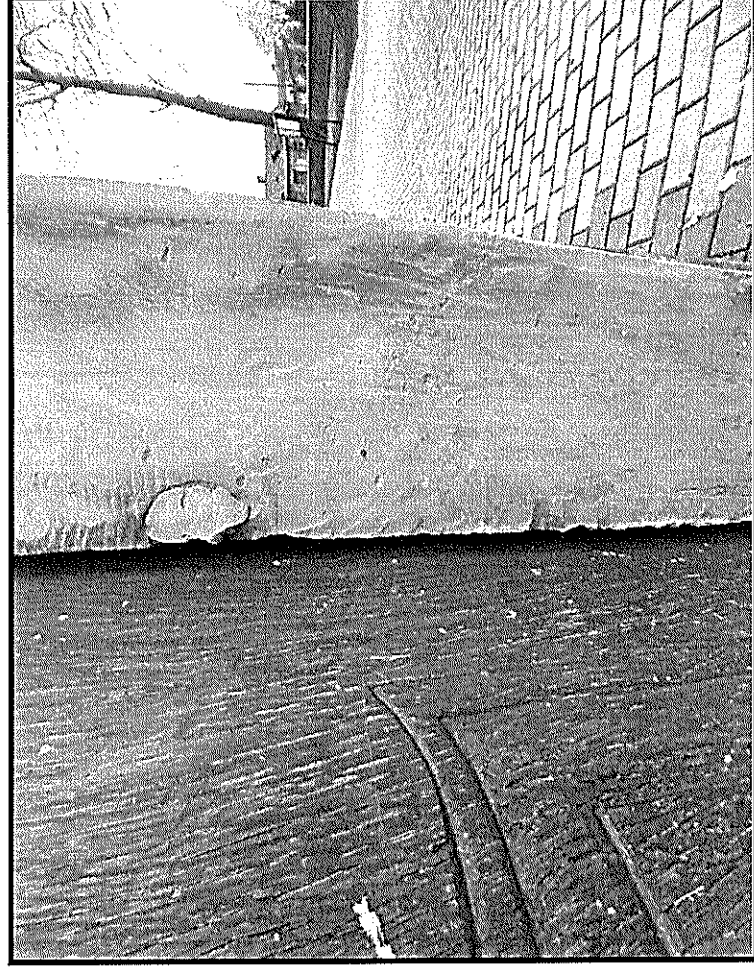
Stan zachowania cokołu elewacji zachodniej kościoła.
